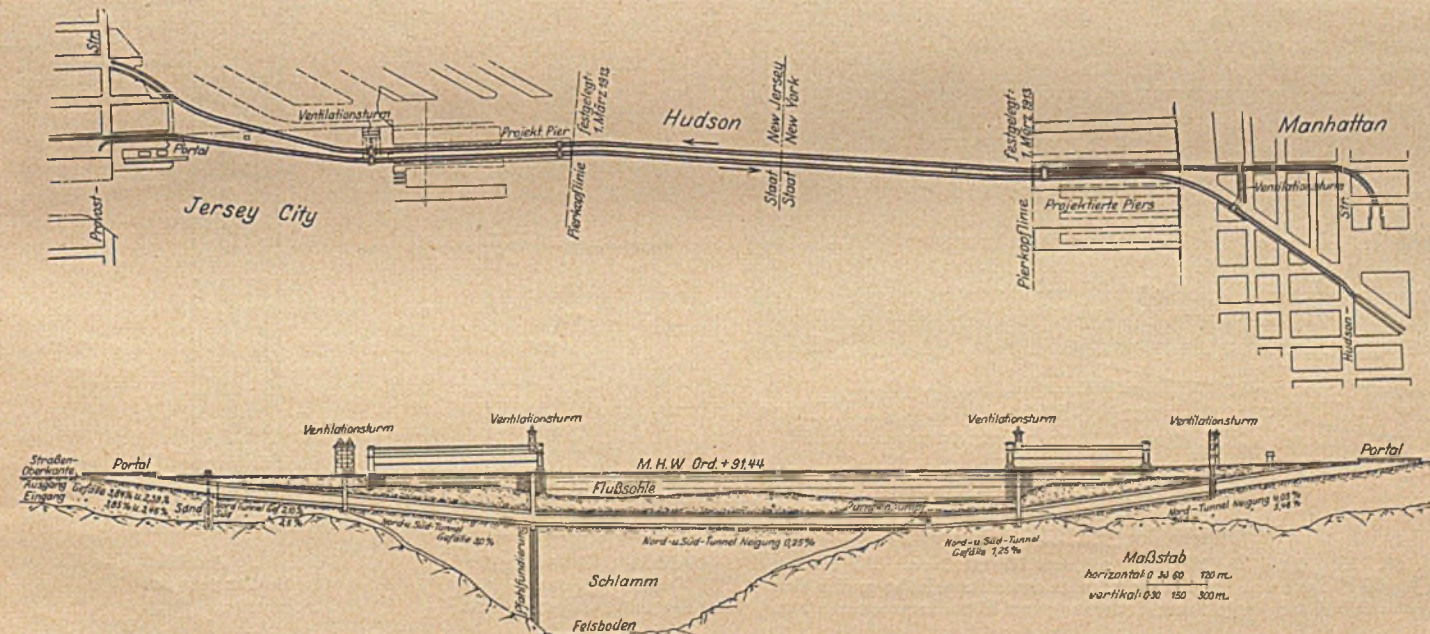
Straßentunnel unter dem Hudson (Holland-Tunnel).
